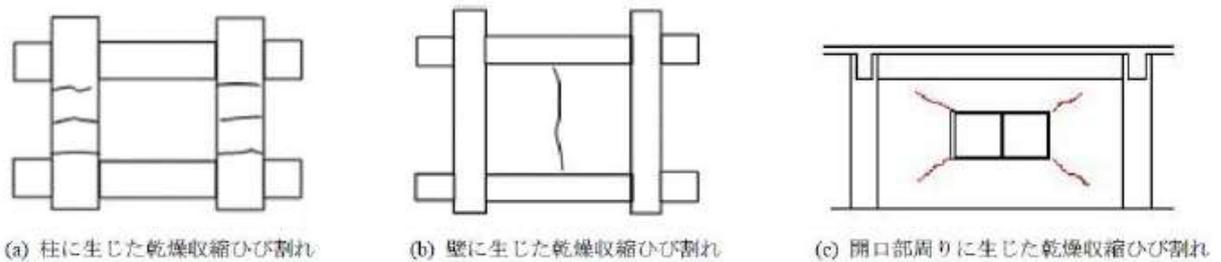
乾燥収縮によるコンクリートのひび割れ
